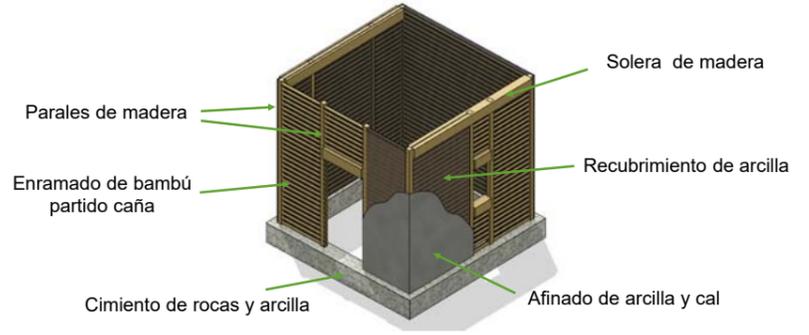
Modelo y elementos constructivos de vivienda de bajareque. (Fuente: Carlos E. Acual, 2021)
